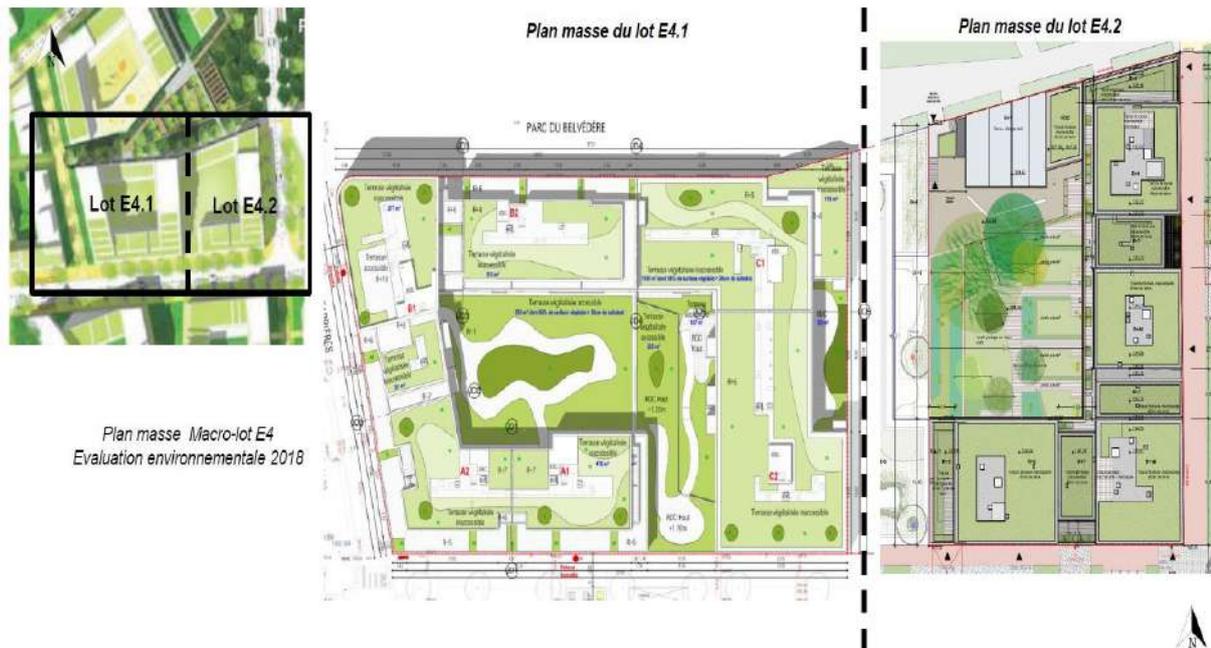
Plan masse des lots E4.1 et E4.2 p.161 étude d'impact
